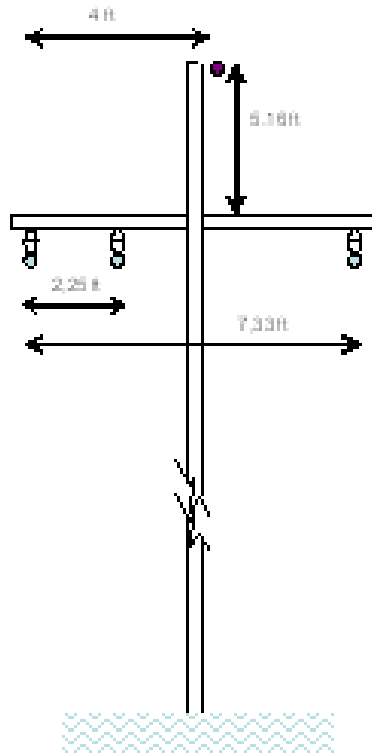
Línea eléctrica 34,5 kV. Detalle de Elevación.
